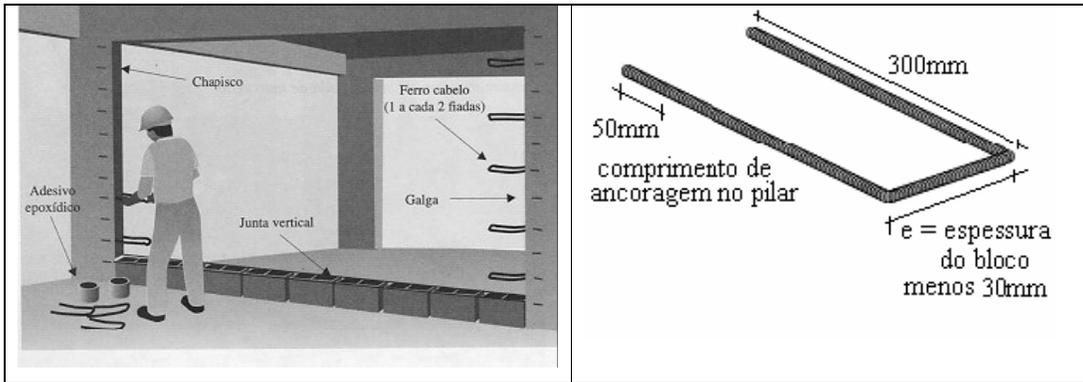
Procedimento da ancoragem da alvenaria no pilar.
